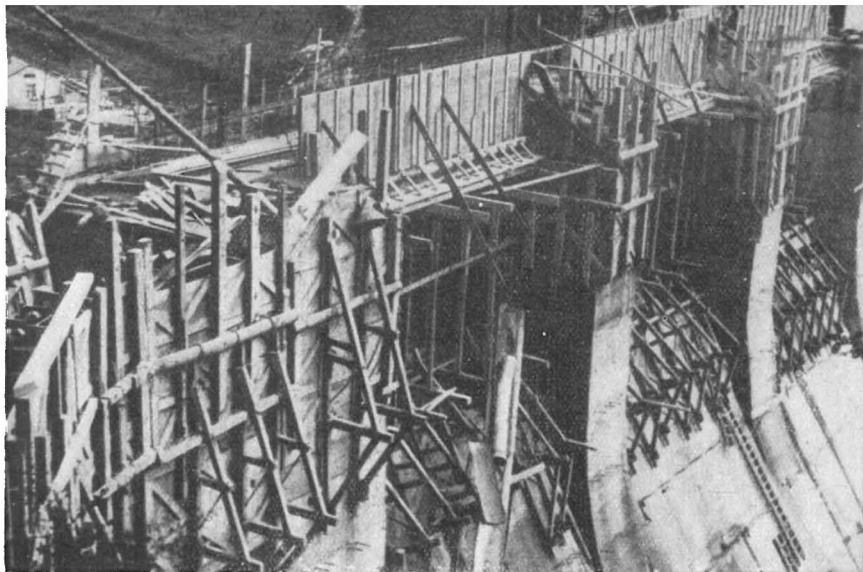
Staumauer Burgkhammer (Saaletal) im Bau
